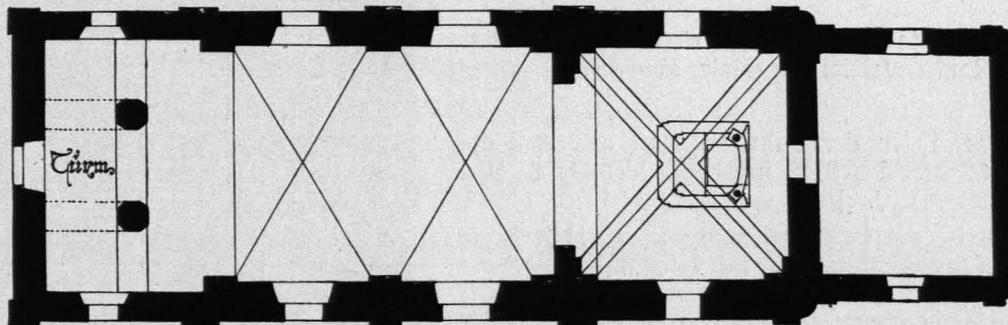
Jagenbach, Pfarrkirche, Grundriß 1:200 (S. 339)
